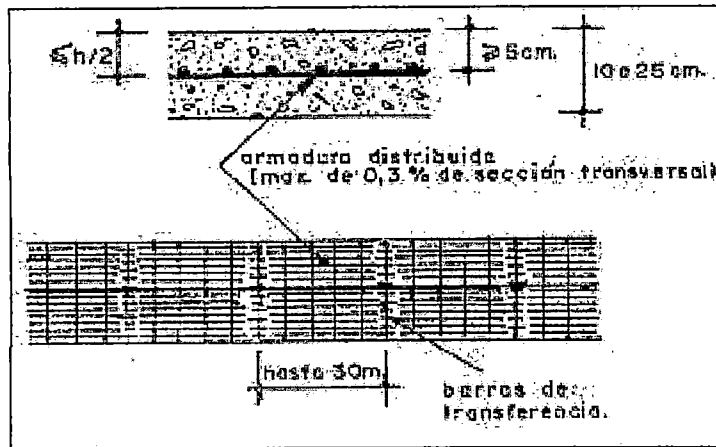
Sección del pavimento con refuerzo de acero no estructural
